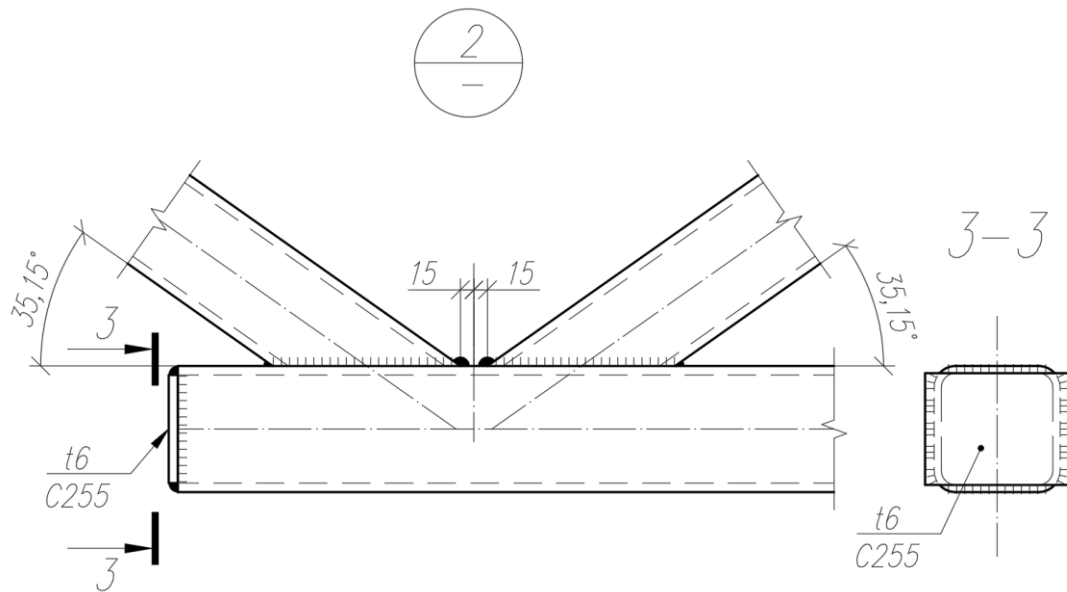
Узел 2 подстропильной фермы ФП-12-71,2.
